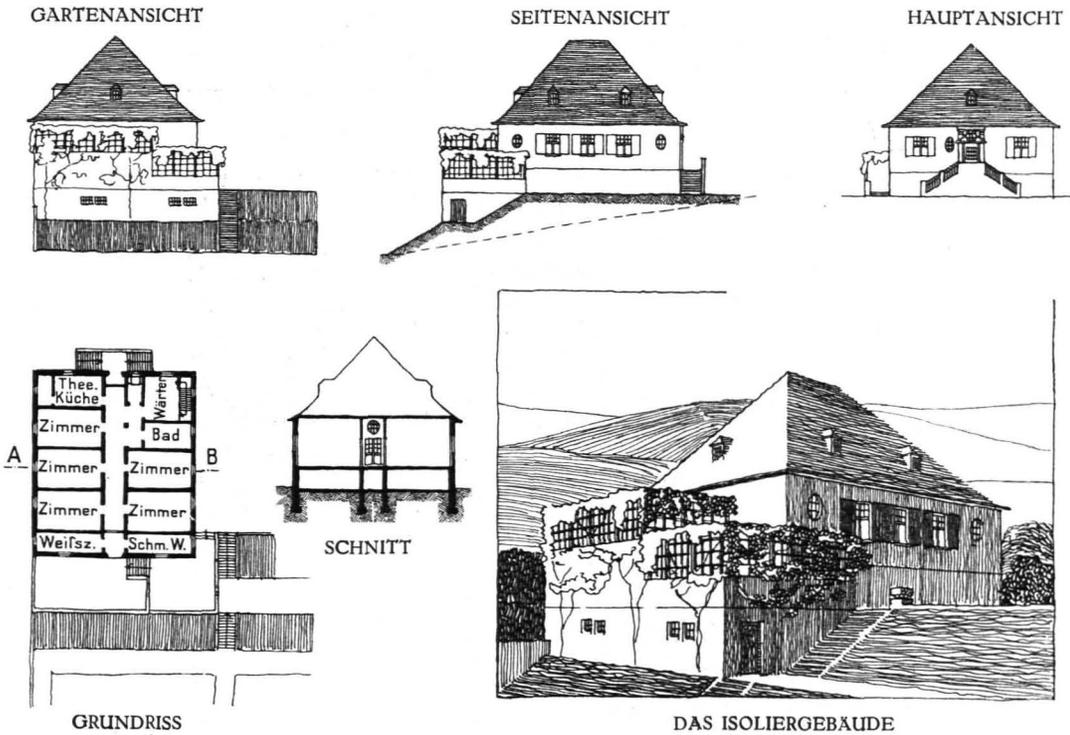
ANSICHTEN UND GRUNDRISS.
